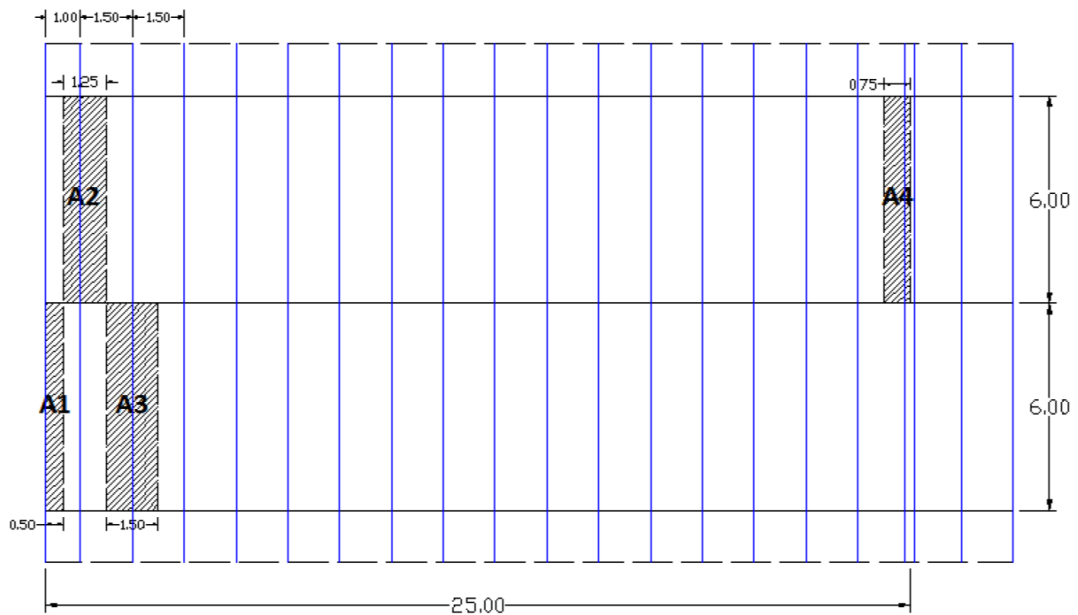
Pórticos con Sección de Alma Llena. Ancho Cooperante de correa.
